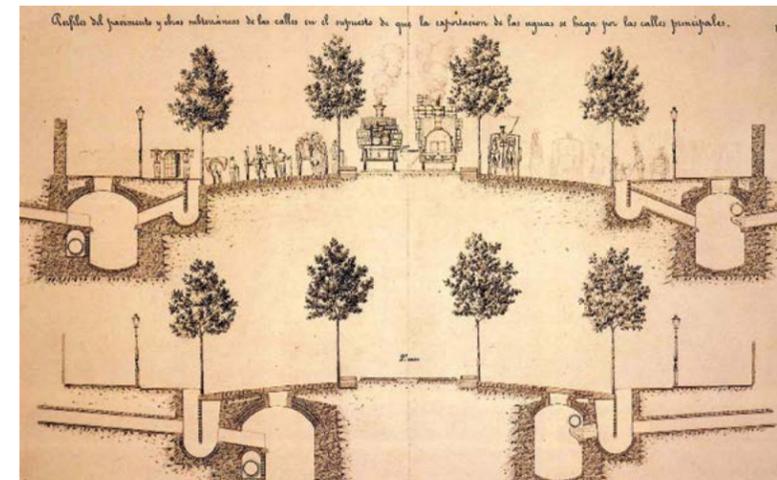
Detalle en sección de una calle, Plan Cerdà 1859.
